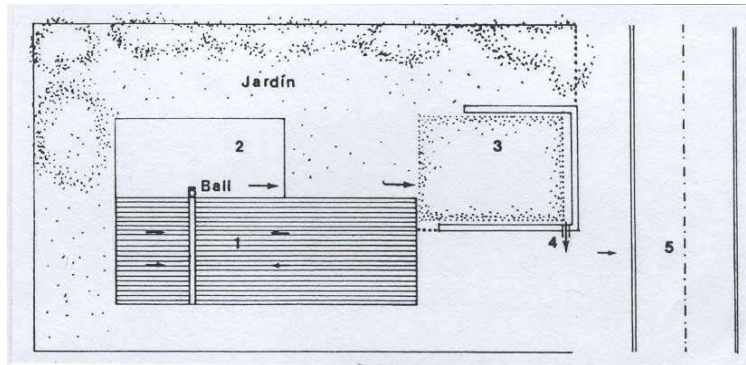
Estanque de infiltración en antejardín. 1.- Techo, 2.- Terraza, 3.- Estanque de infiltración, 4.- Rebase, 5.- Calle.
